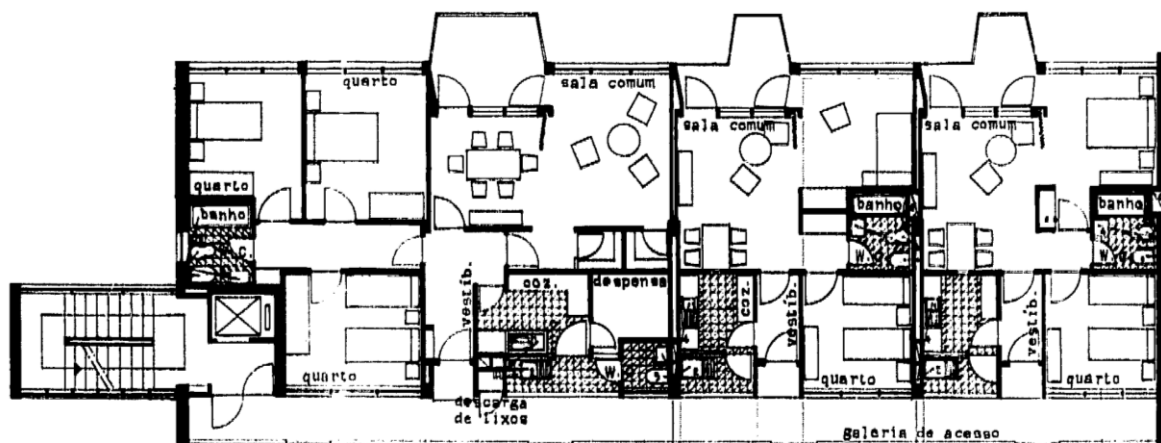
Planta de arquitectura do piso tipo (R/C ao Piso 4).
